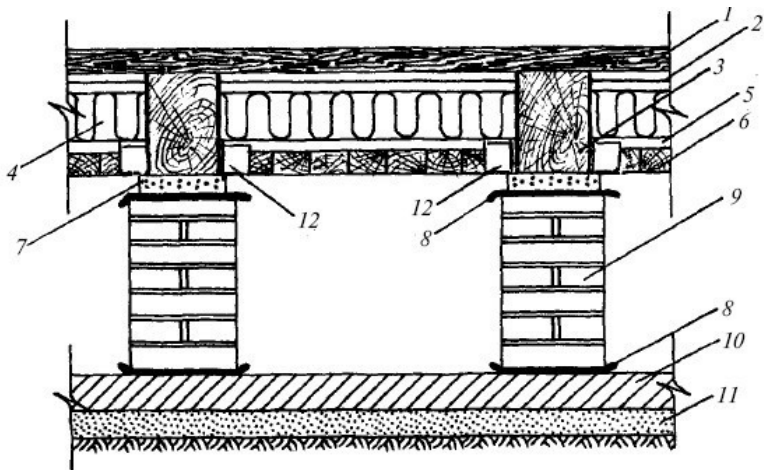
Утепление пола по деревянным лагам на кирпичных столбах укладкой теплоизоляции на щиты, укрепленные по черепным брускам: 1 – пол; 2 – пароизоляция; 3 – несущие балки; 4 – теплоизоляционные плиты ЛАЙТБАТТС; 5 – щиты; 6 – нижняя обшивка из досок; 7 – антисептированная прокладка из дерева; 8 – гидроизоляция; 9 – кирпичные столбики; 10 – бетонная подготовка; 11 – песок утрамбованный; 12 – черепные бруски
